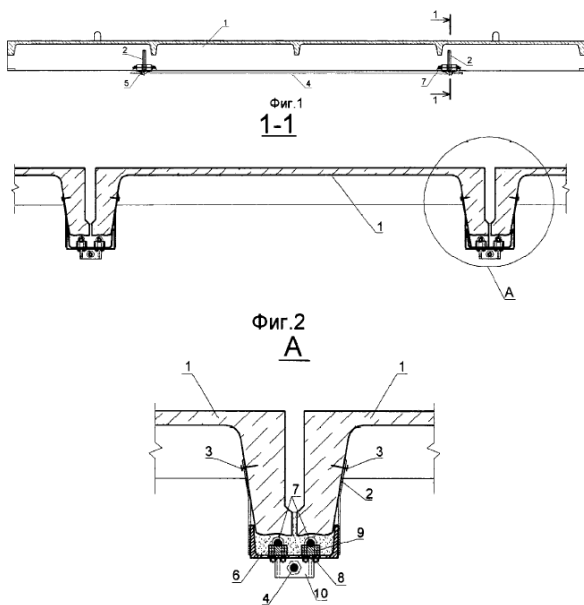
Устройство для усиления покрытия из железобетонных ребристых плит
